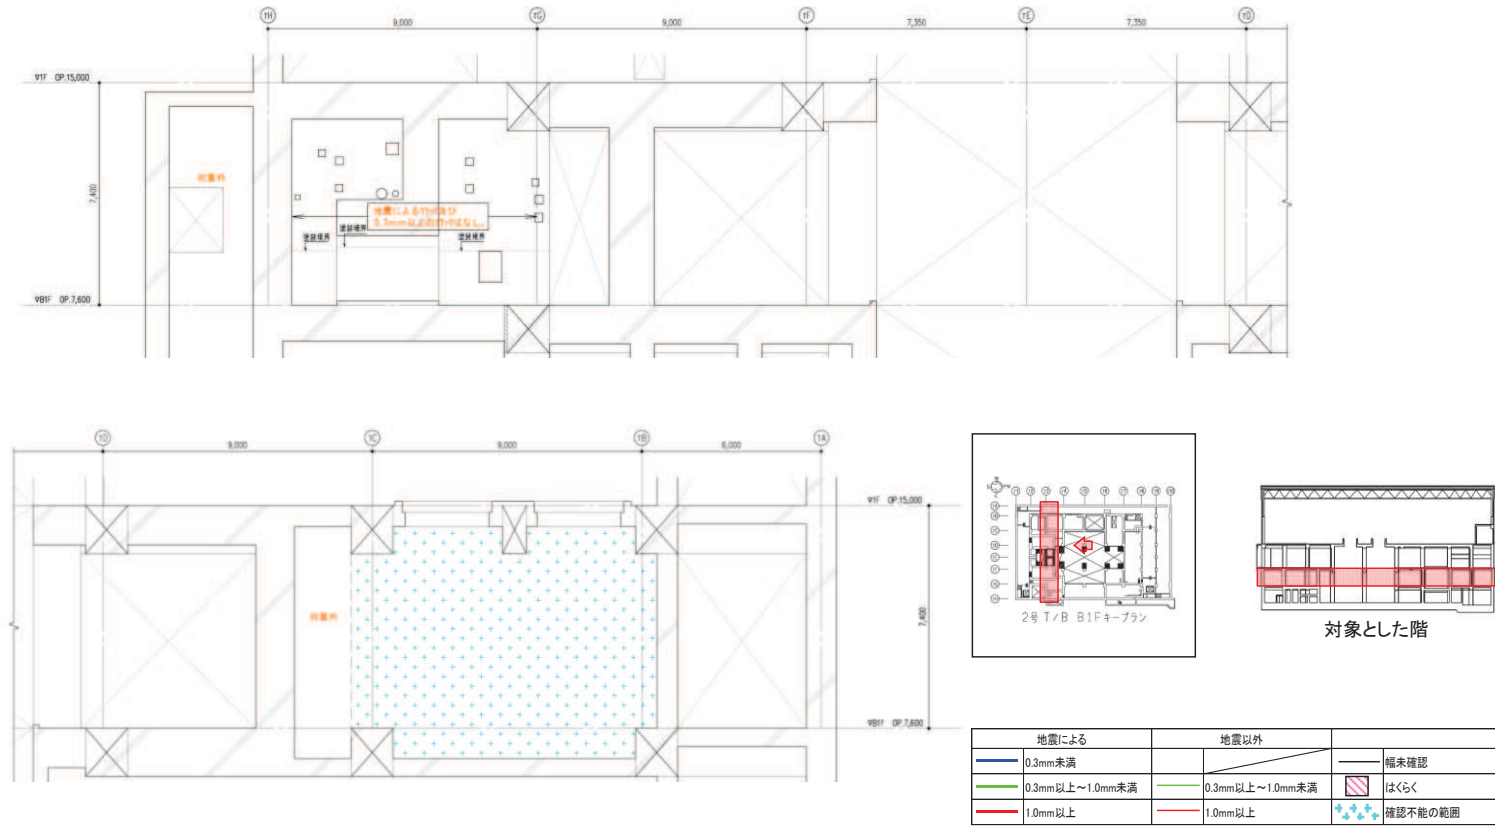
タービン建屋のひび割れ分布 耐震壁 (19) 地下1階 T3 通り
